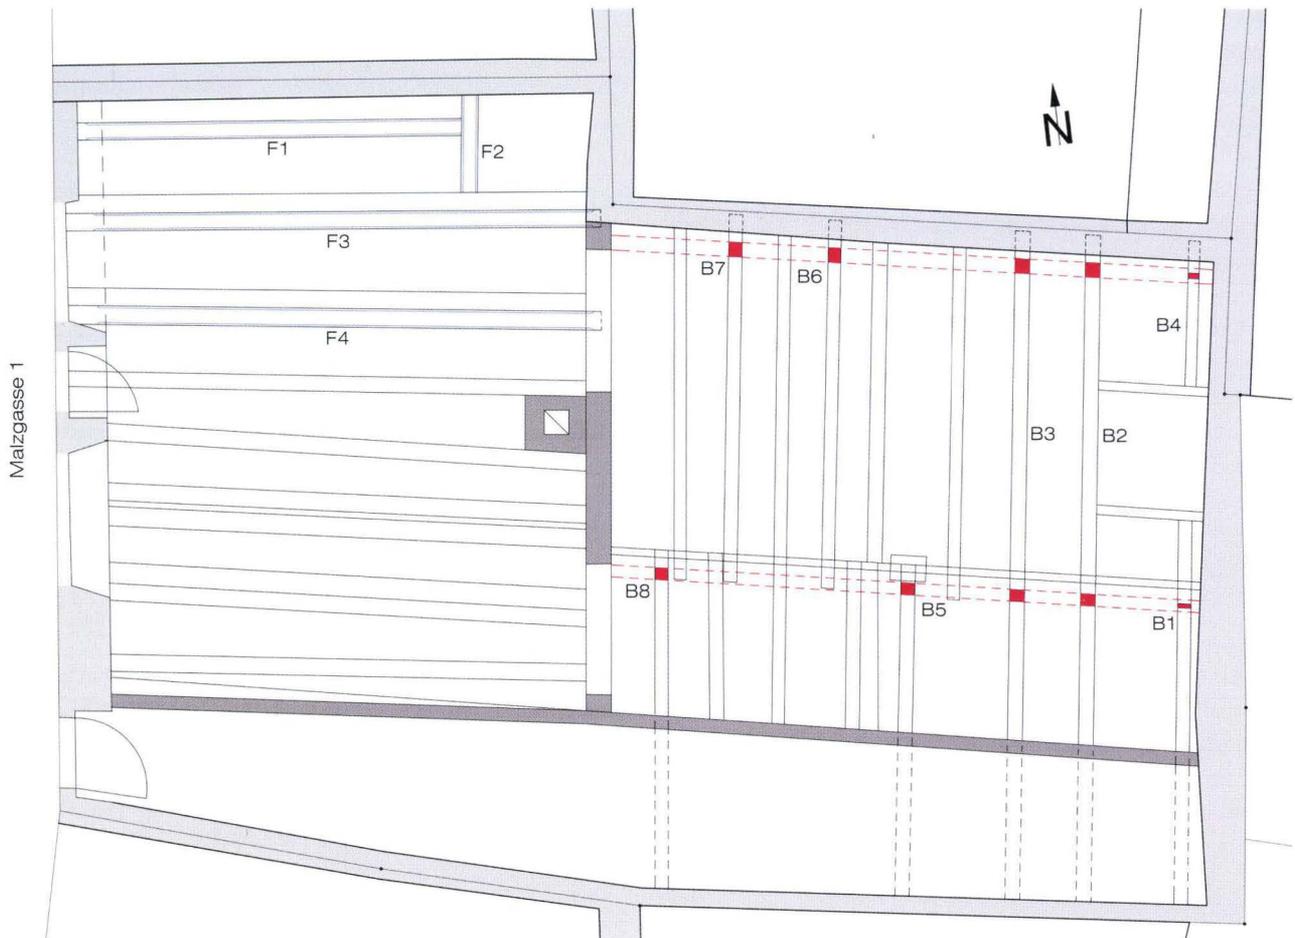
Malzgasse 1. Grundriss Erdgeschoss. Die eingezeichneten Deckenbalken weisen im hofseitigen Hausteil auf den Unterseiten 22 cm breite Ausnutungen auf, die auf eine ältere Riegelkonstruktion hinweisen (rot markiert). Im strassenseitigen Hausteil sind die Deckenbalken, welche mit einer Zierfase ausgestattet sind, mit einem F versehen. – Plan: Hans Ritzmann.
